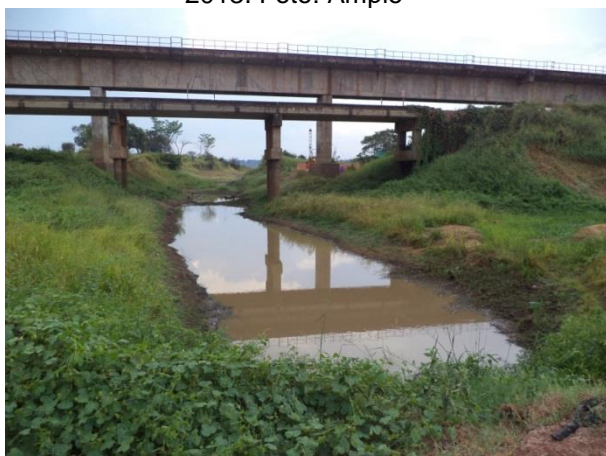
Montante da travessia 83 em outubro de 2013. Foto: Ampla
